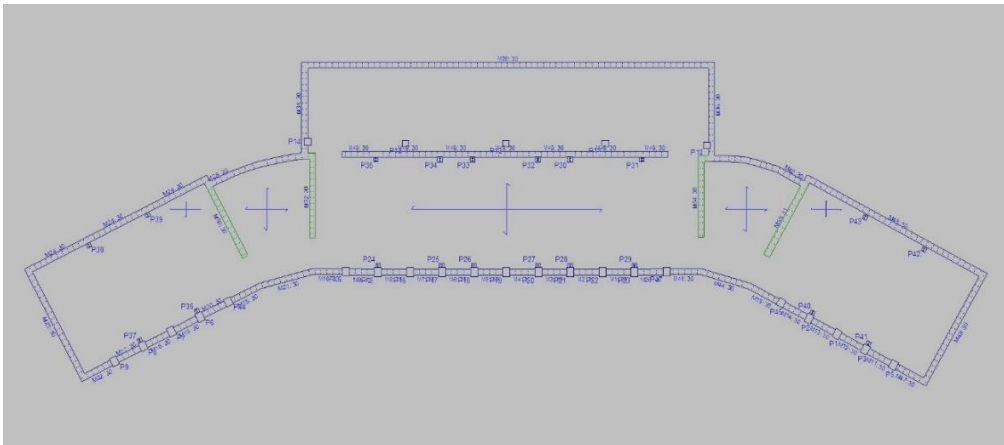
Planta 3 del modelo de 5 plantas simplificado
